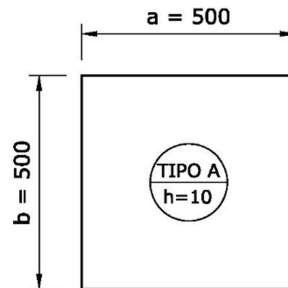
Modelo estrutural da Laje 1 (Tipo A)
